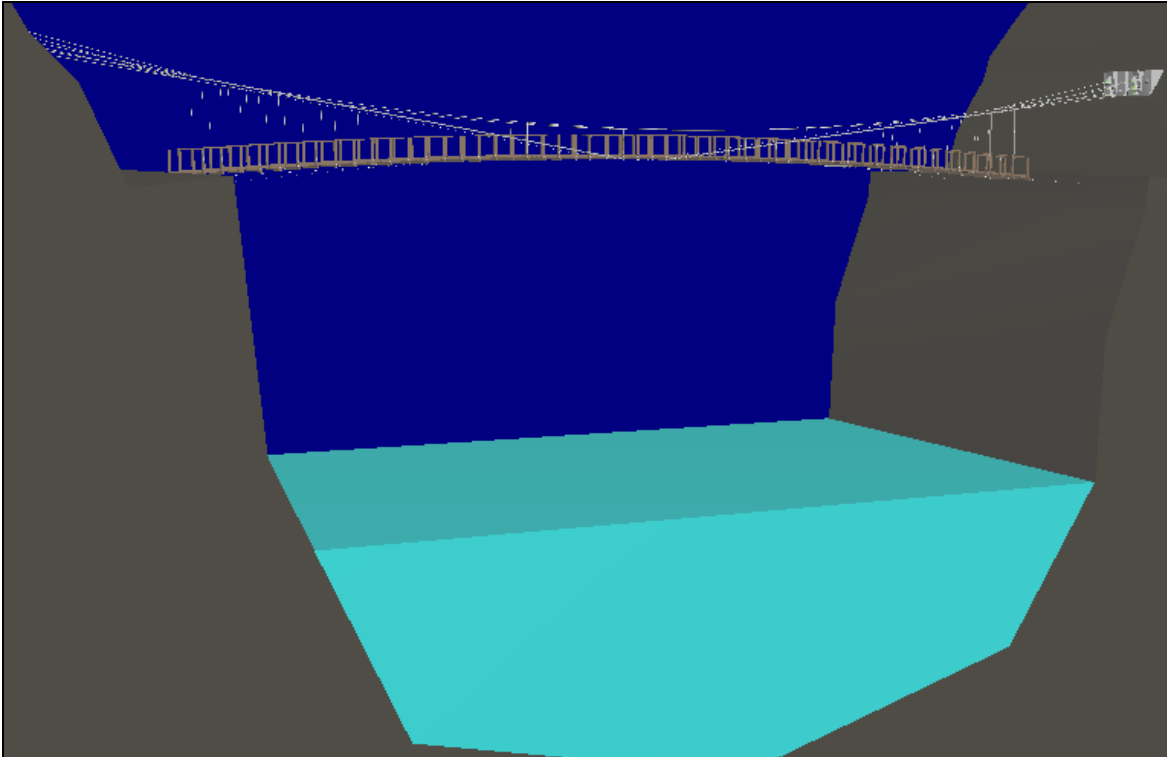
Vista em perspectiva da estrutura proposta.
